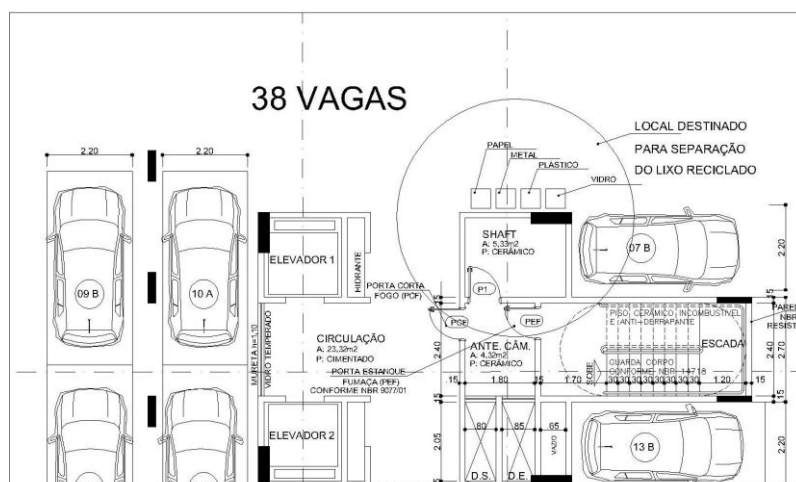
Planta do subsolo do empreendimento (Lixo Reciclado- SEPARAÇÃO).
